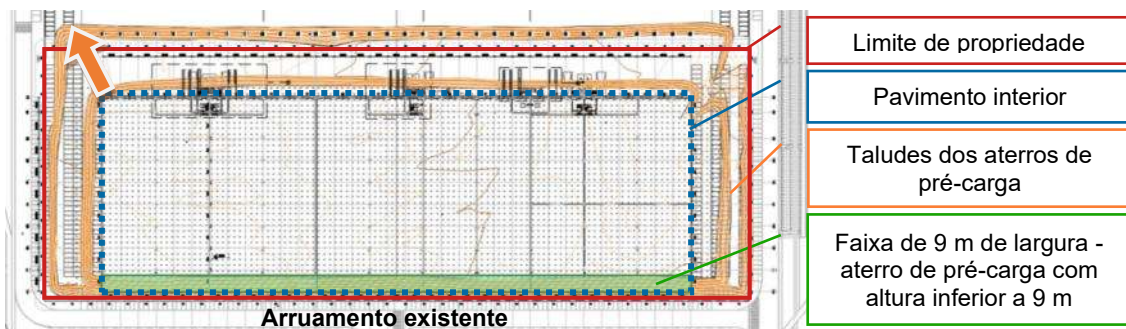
Planta de implantação da estrutura a construir, sobre levantamento topográfico dos aterros de pré-carga (sem escala)
